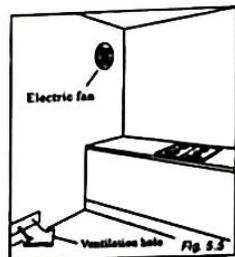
Рис. 5.5, Electric fan – электрический вентилятор, Ventilation hole - вентиляционное отверстие
